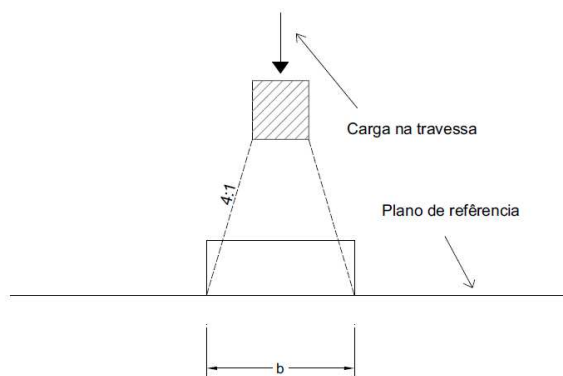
Distribuição longitudinal da carga pela travessa e balastro (adaptado de [24])
